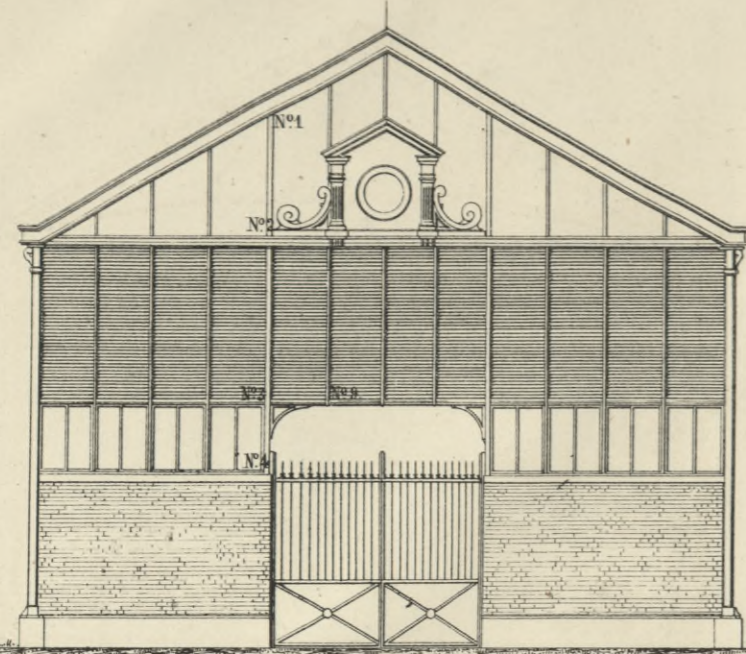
Elevation longitudinale à 0^m,009 pour 1^m,00.
